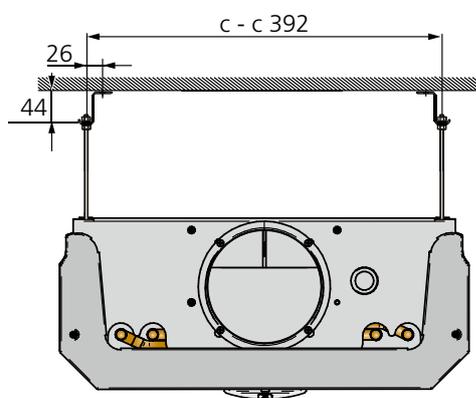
Montage – abgependelte Montage mit Montageteil SYST MS-M8.
